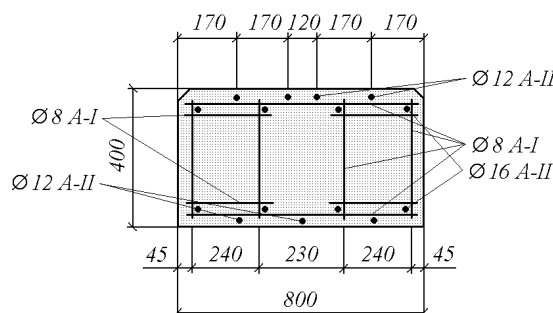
Схема армирования поперечного сечения балки (составлен авторами)
